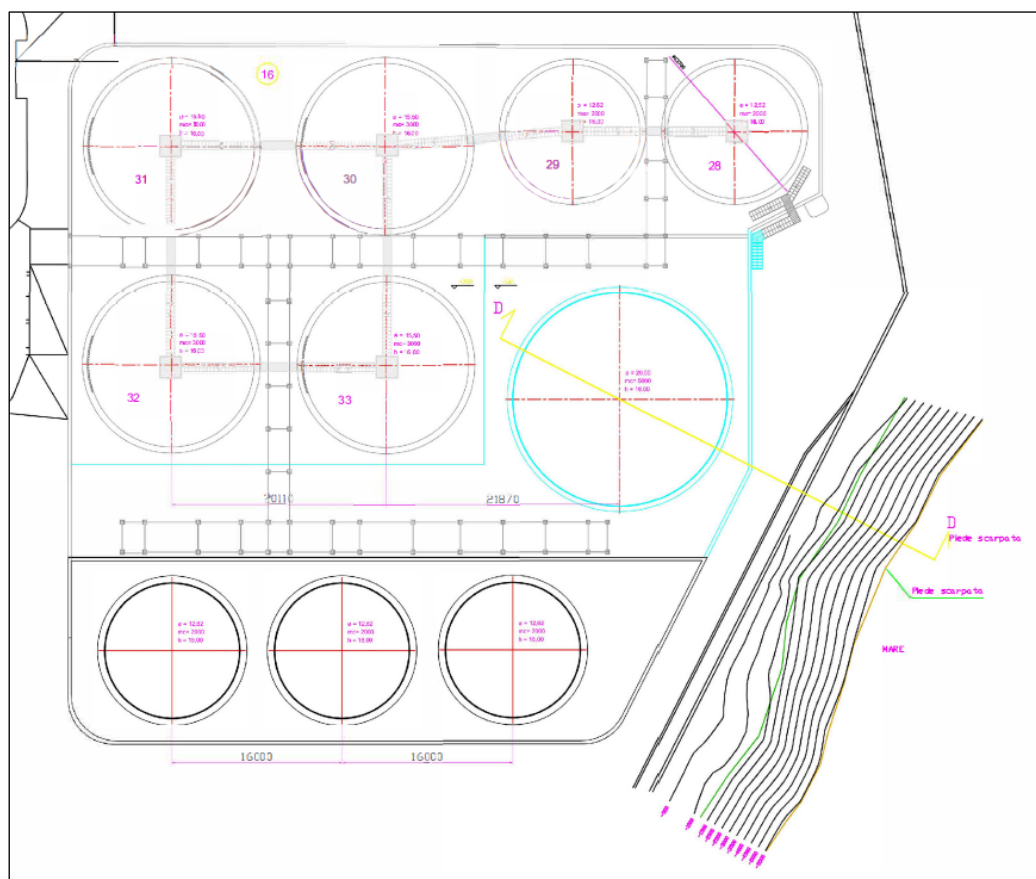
Planimetria e ubicazione sezione verifiche di stabilità
